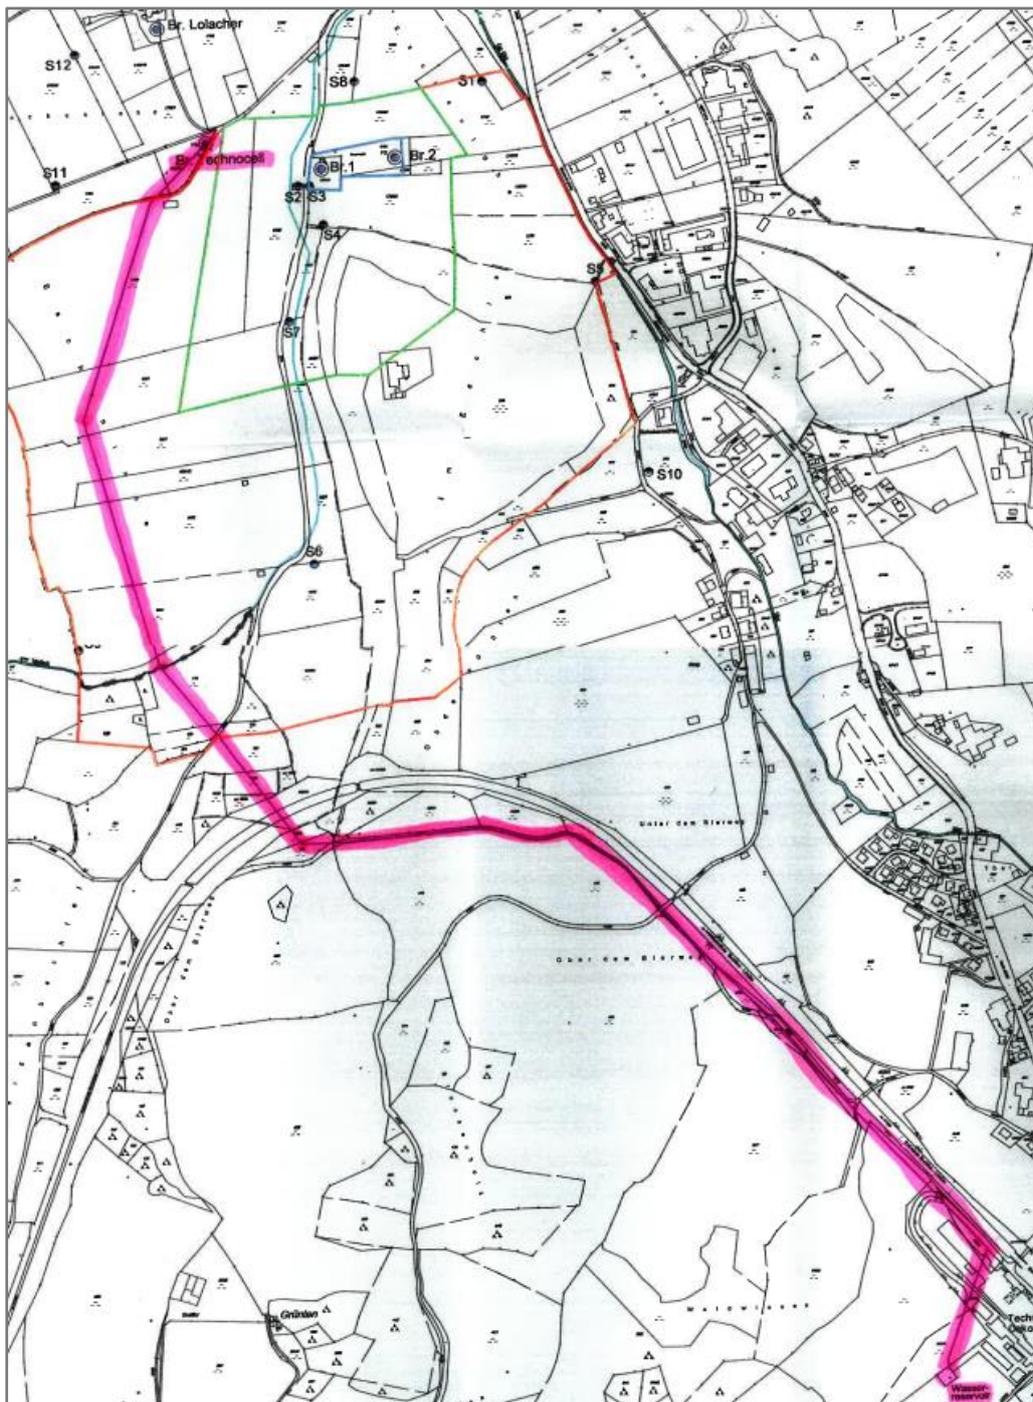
Lageplan mit Verlauf der Druckleitung vom Brunnenstandort zum Hochbehälter.
